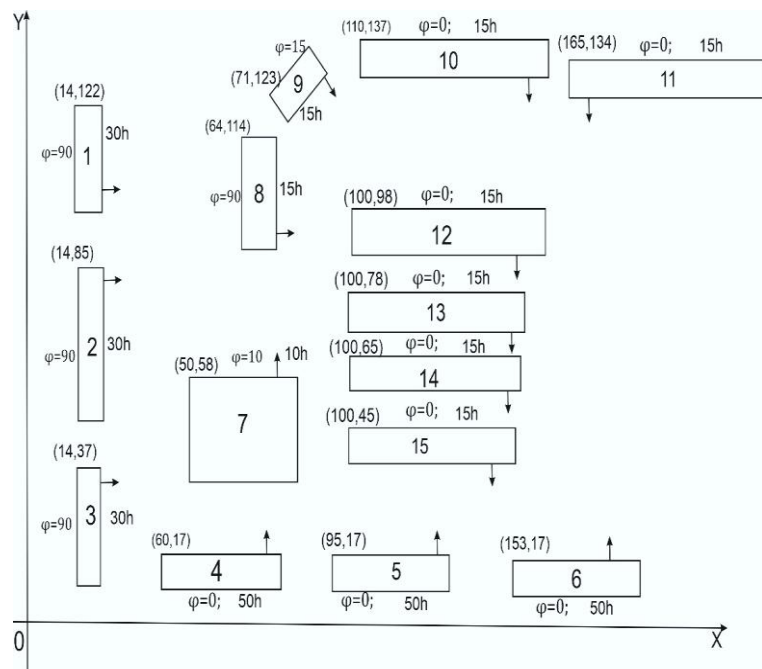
План размещения объектов жилого микрорайона для расчета инсоляции (основание таблицы 1И)
